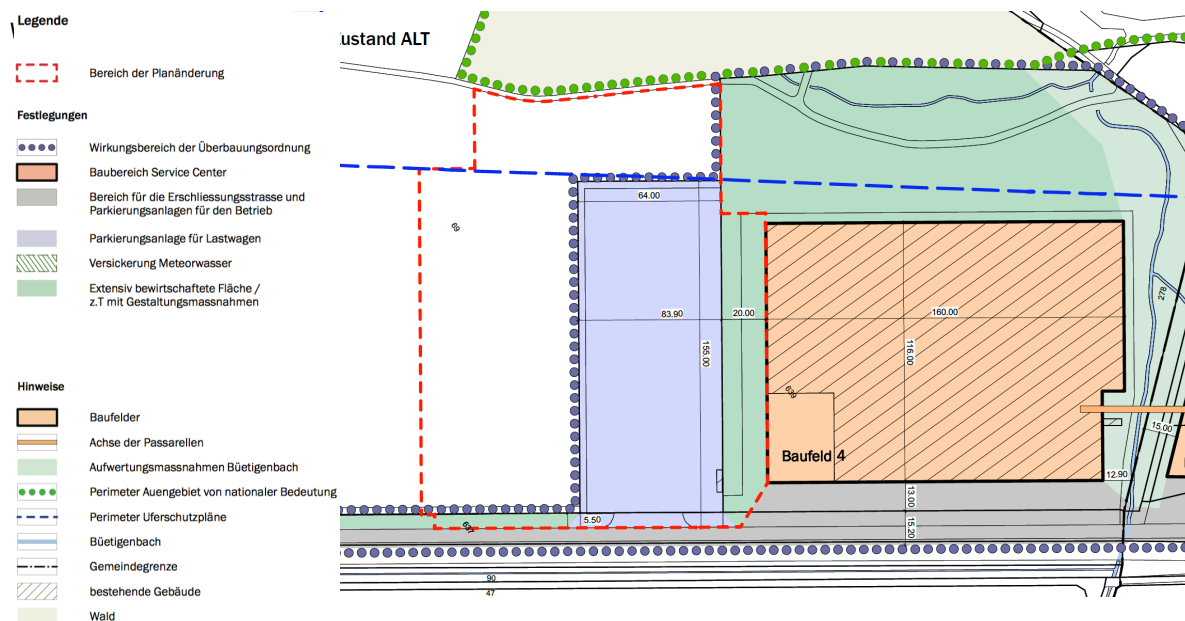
Überbauungsplan alt mit Änderungsperimeter (rot gestrichelte Linie)
